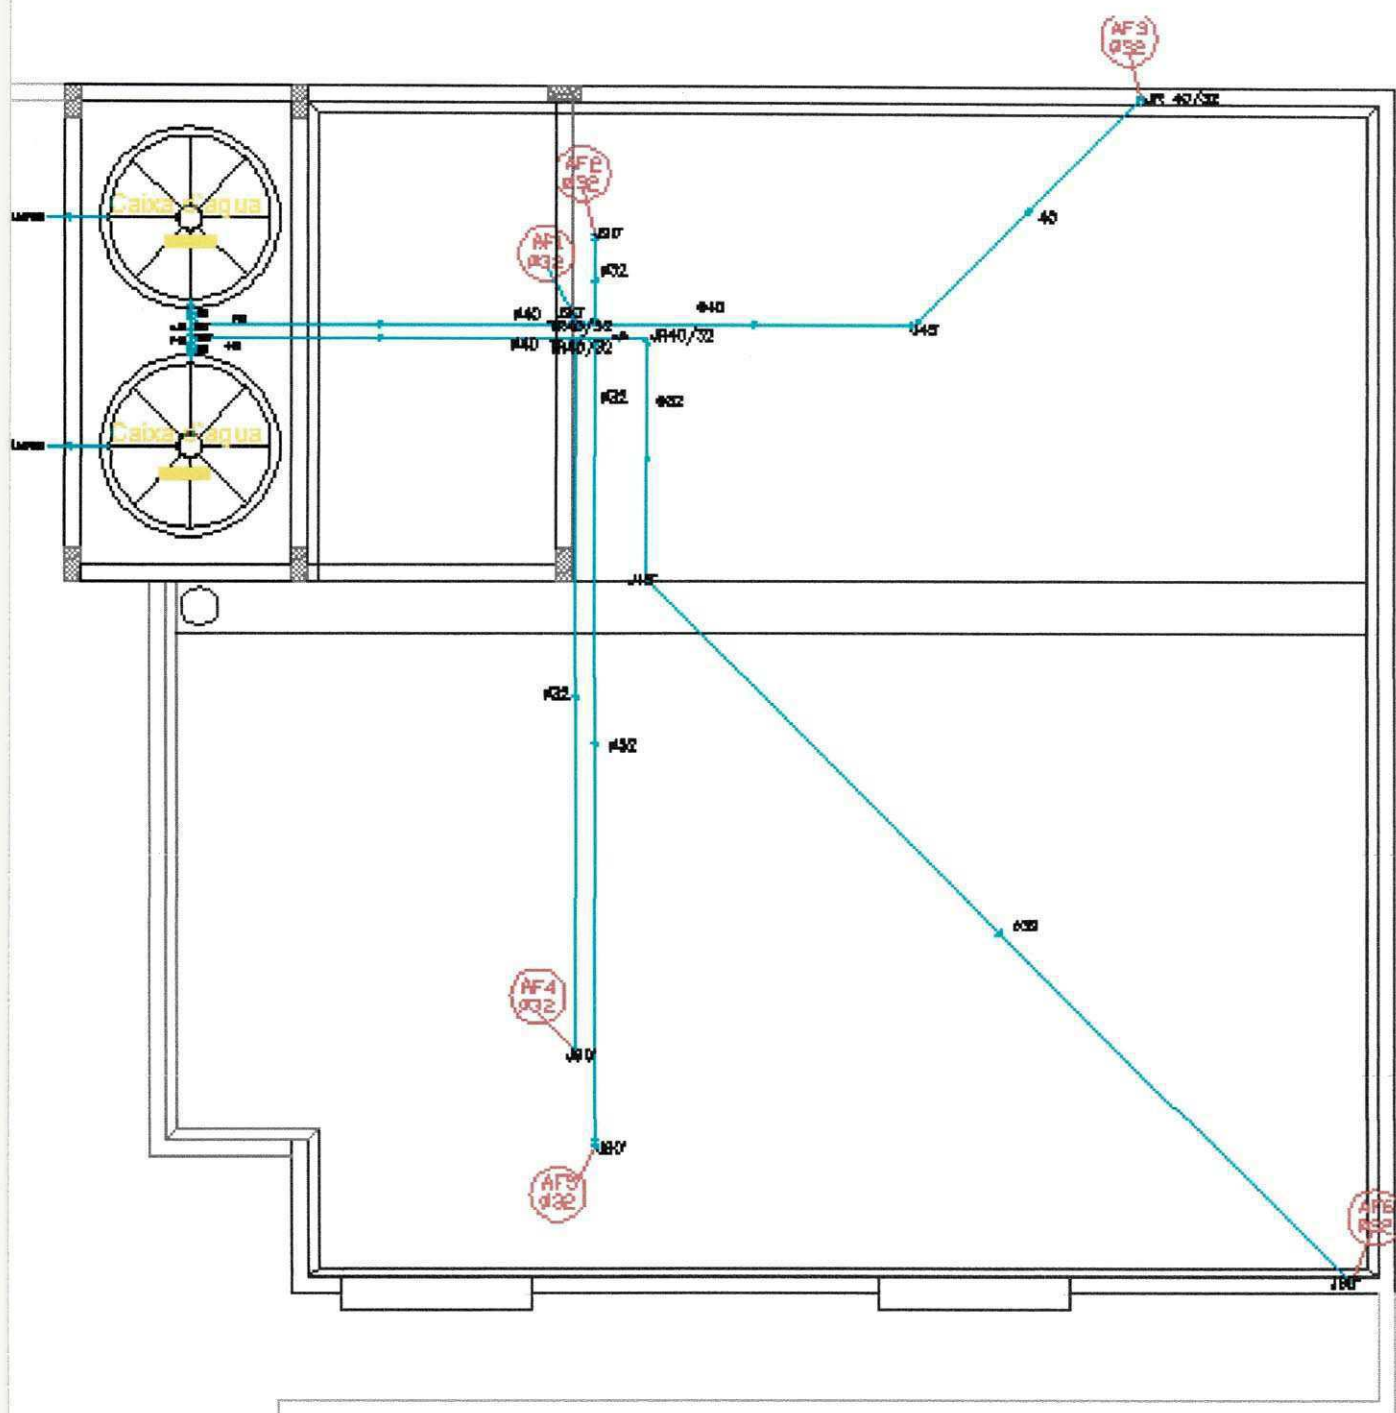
Projeto hidráulico edifício Sara planta baixa de coberta
